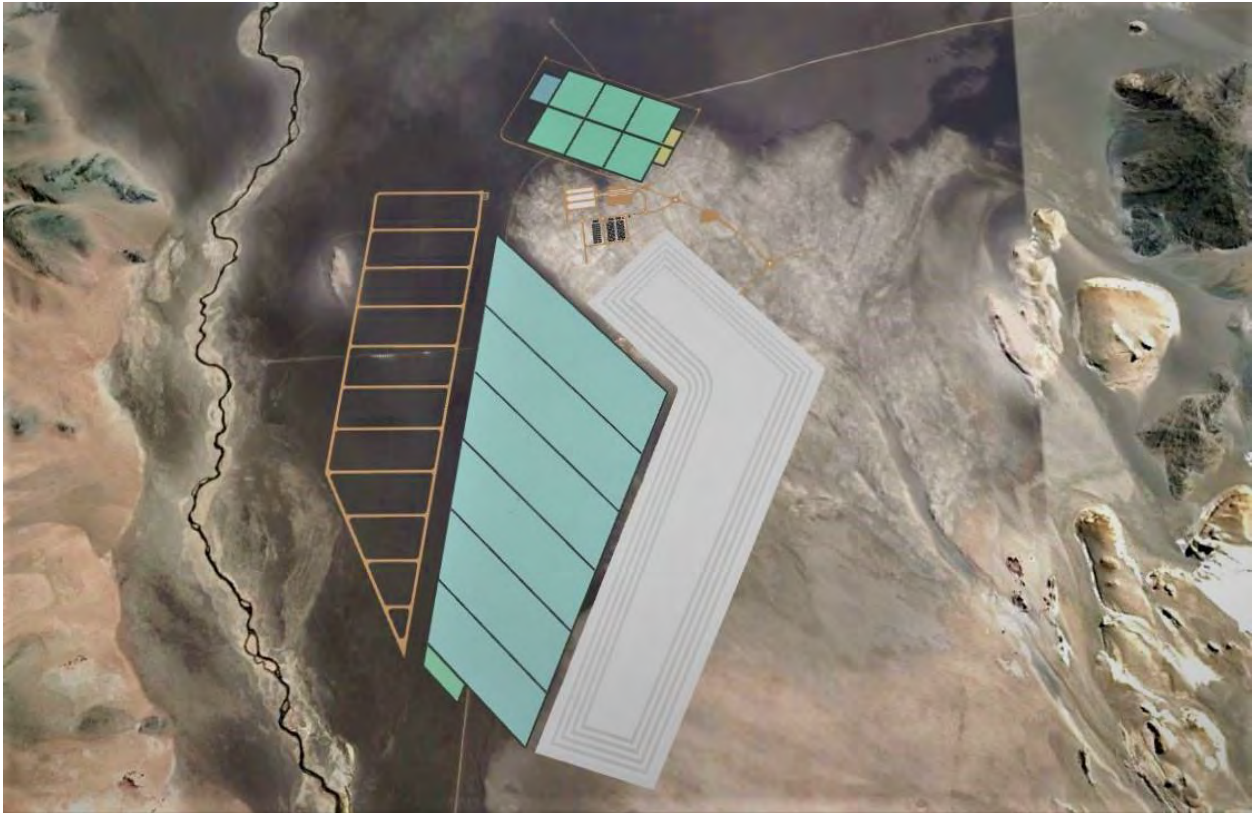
Vista en planta de las piletas de evaporación, planta de procesamiento y de los acopios de sales de cosecha.
